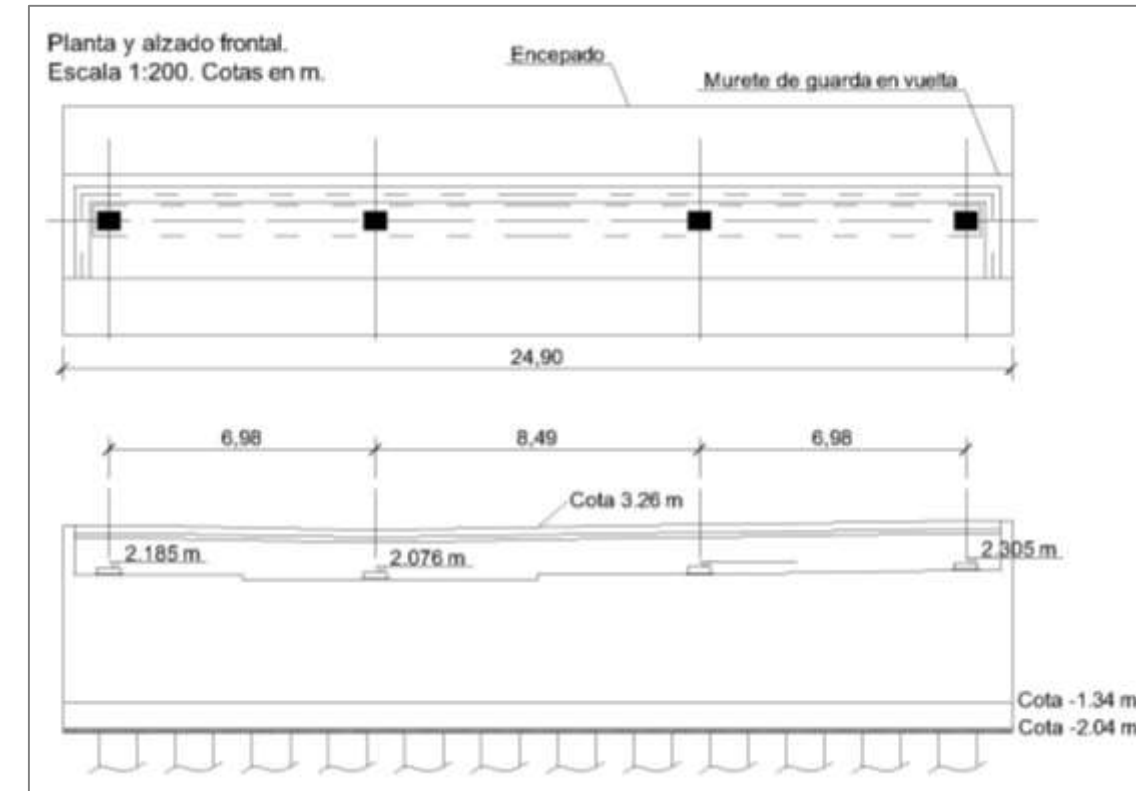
Planta y alzado del estribo. Fuente: Elaboración propia.
